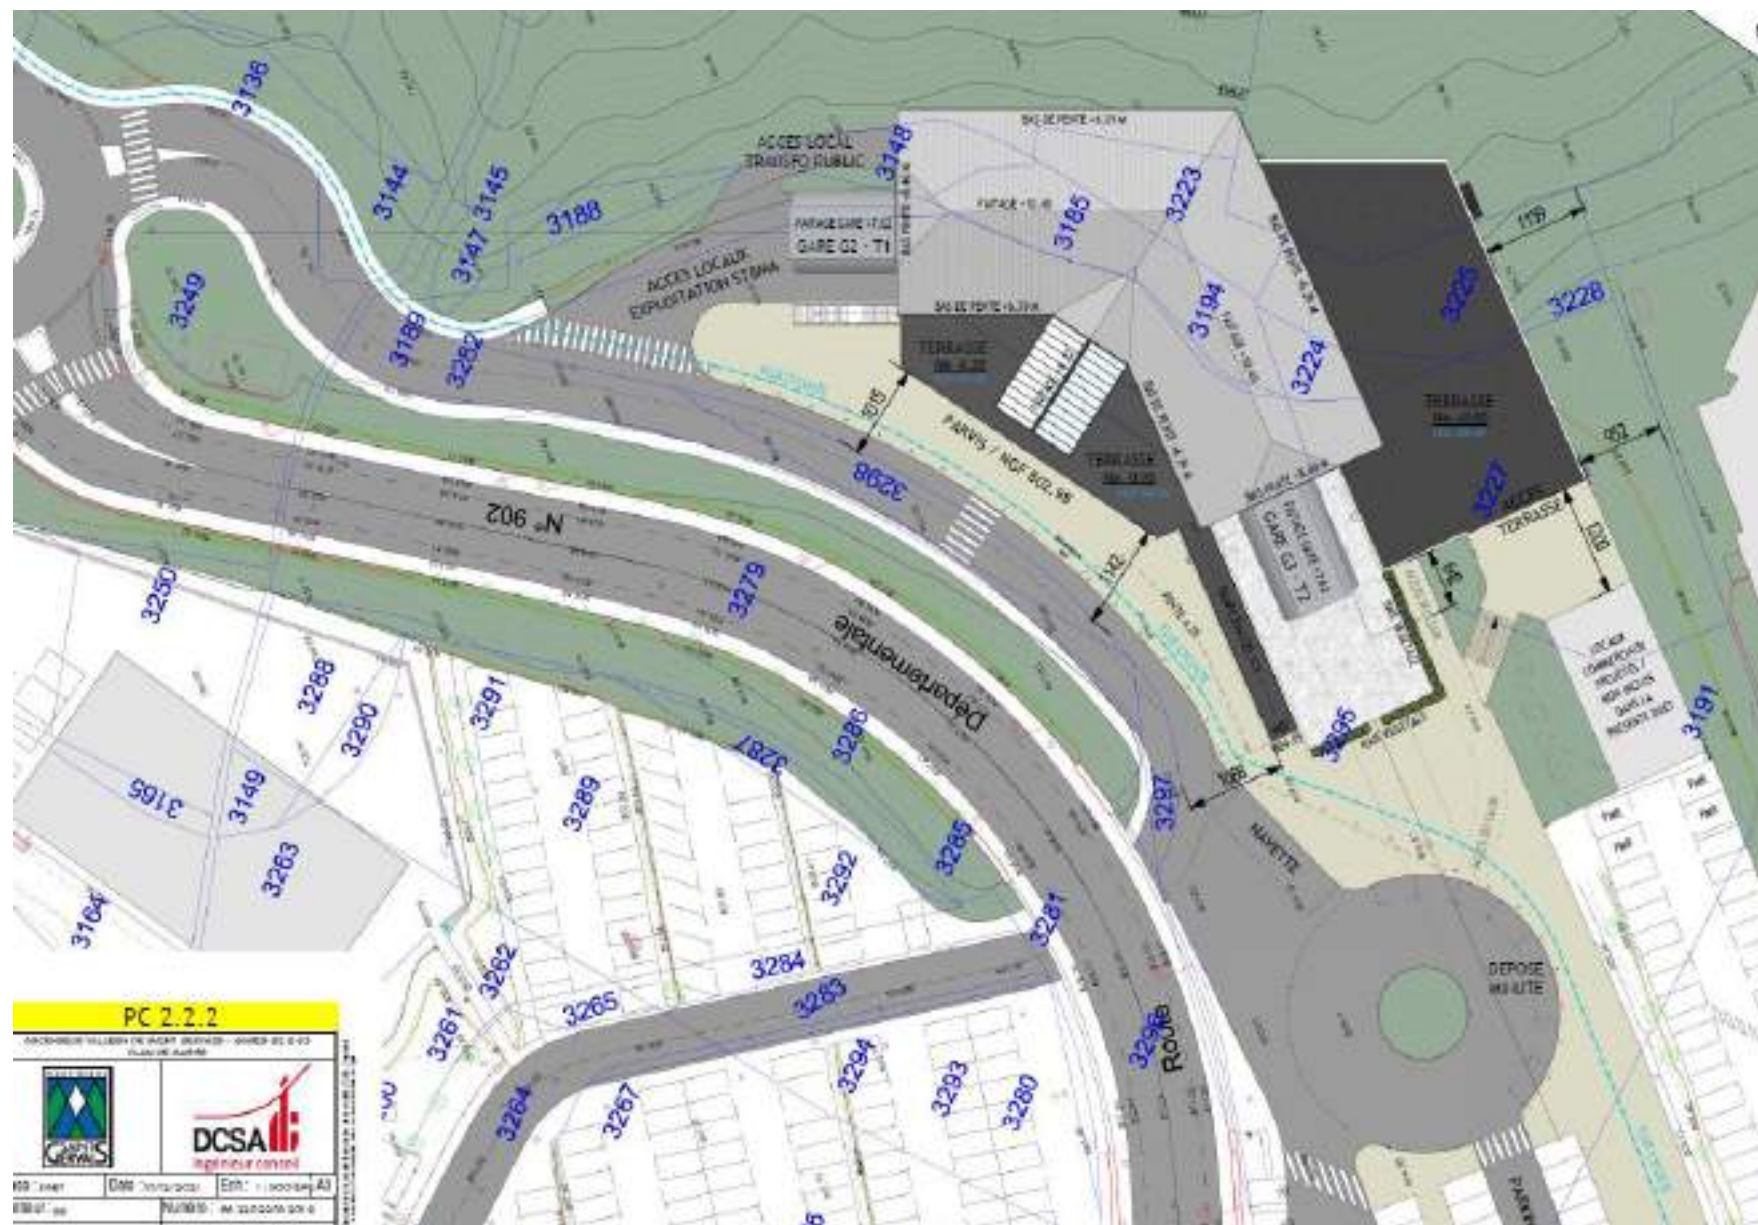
Plan masse de la gare amont (source : DCSA, PC)
